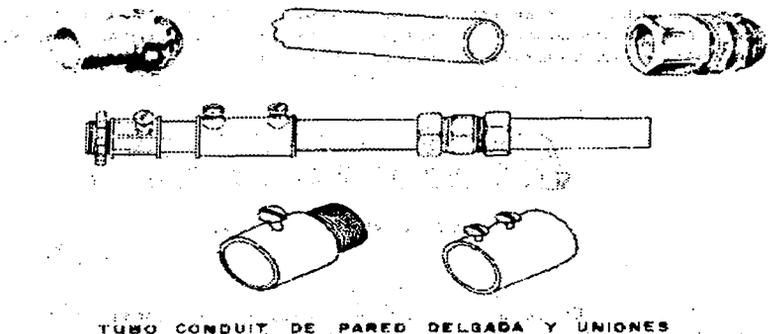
Tubo (conduit) metálico tipo ligero ó de pared delgada
